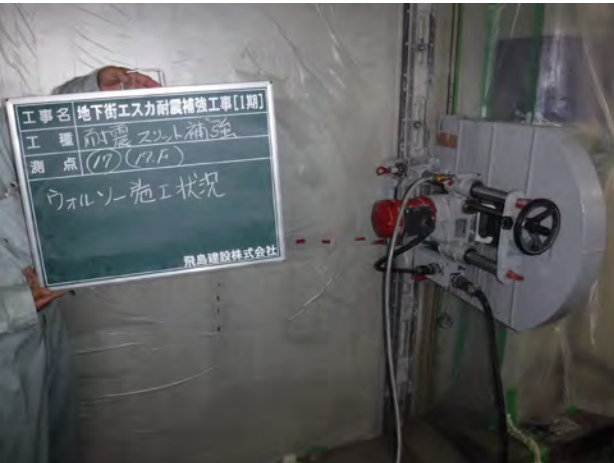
耐震スリット施工状況（地下街躯体柱 B2F）
